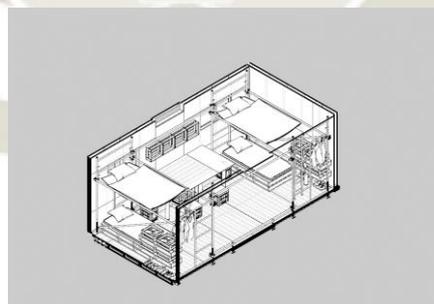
Vista externa de colocación de vanos y culminación de tercera etapa.
